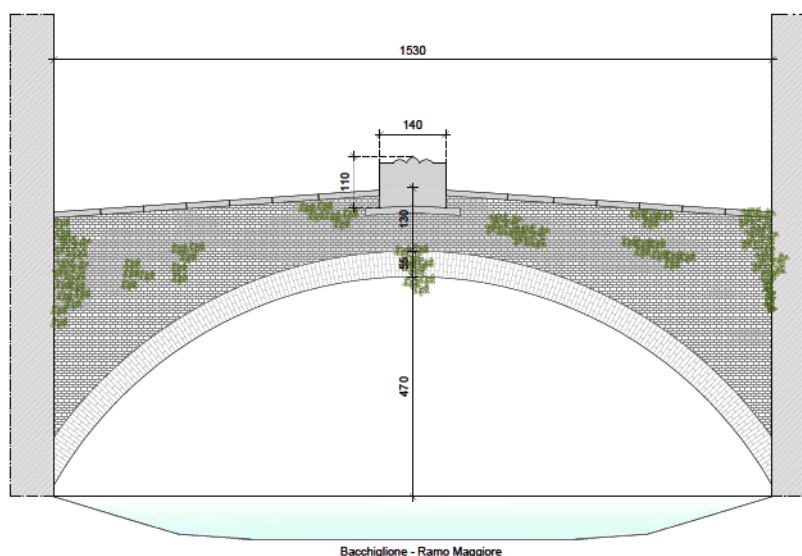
Prospetto di monte del Ponte San Leonardo
